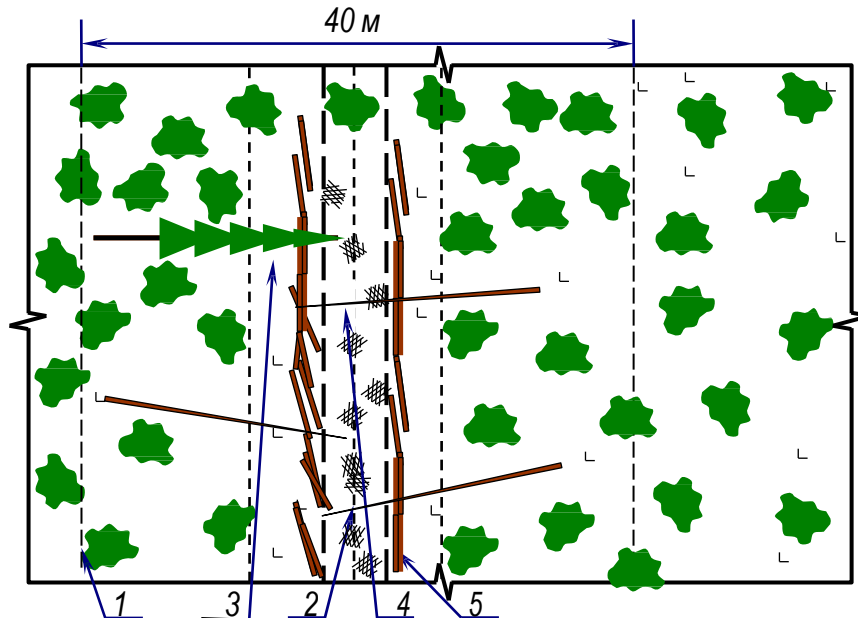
Схема разработки лесопосадки методом средних пасек (вариант 3):
